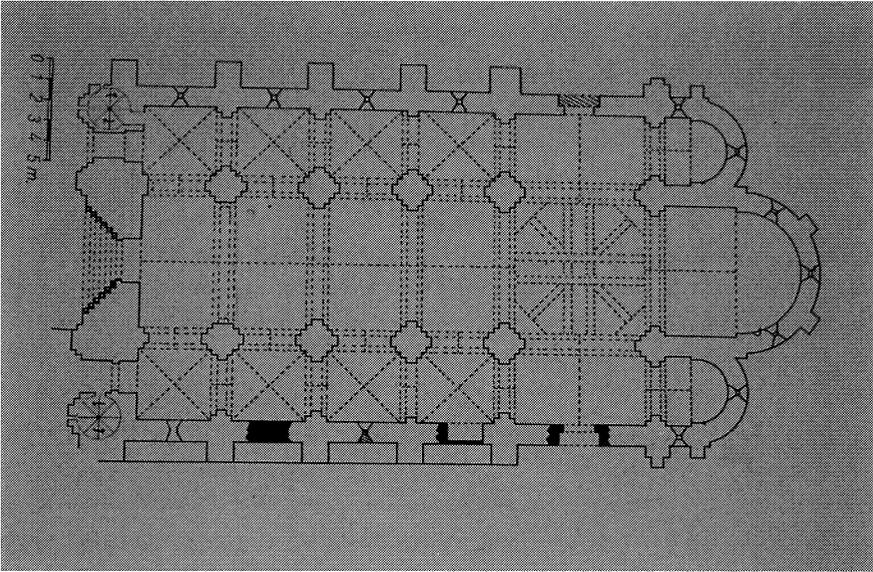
Monasterio de Santa María de Armenteira. Planta de la Iglesia.
